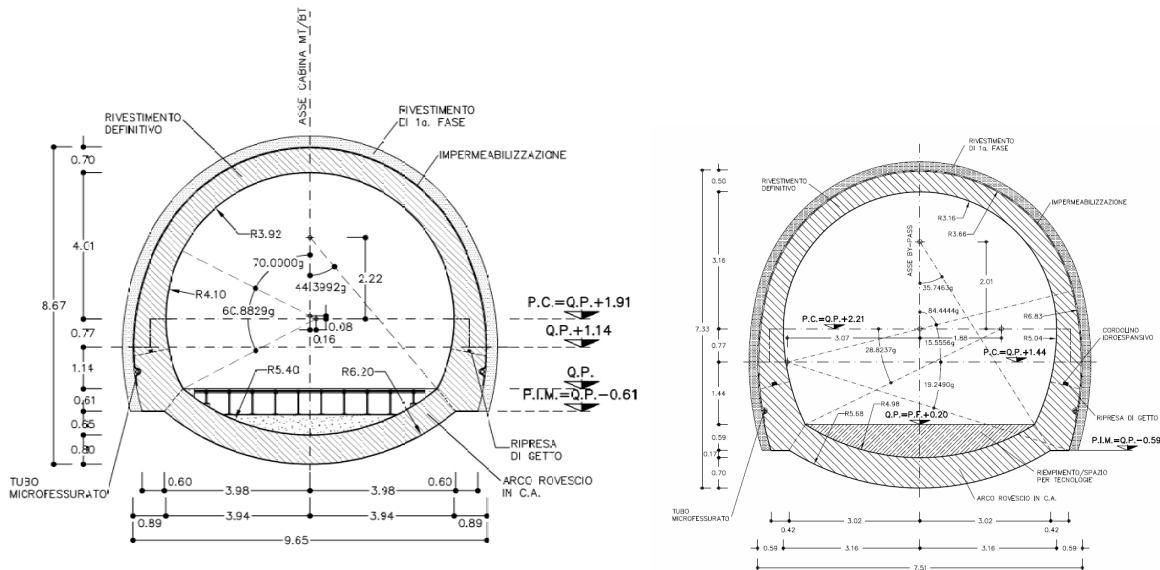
Dettaglio carpenteria PE: sezione allargata (cabina MT/BT, sinistra); sezione corrente (destra)
